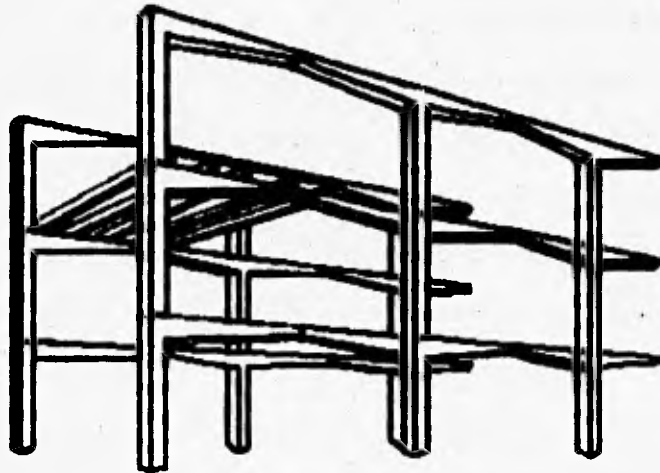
MARCOS ELABORADOS CON COLUMNAS.
